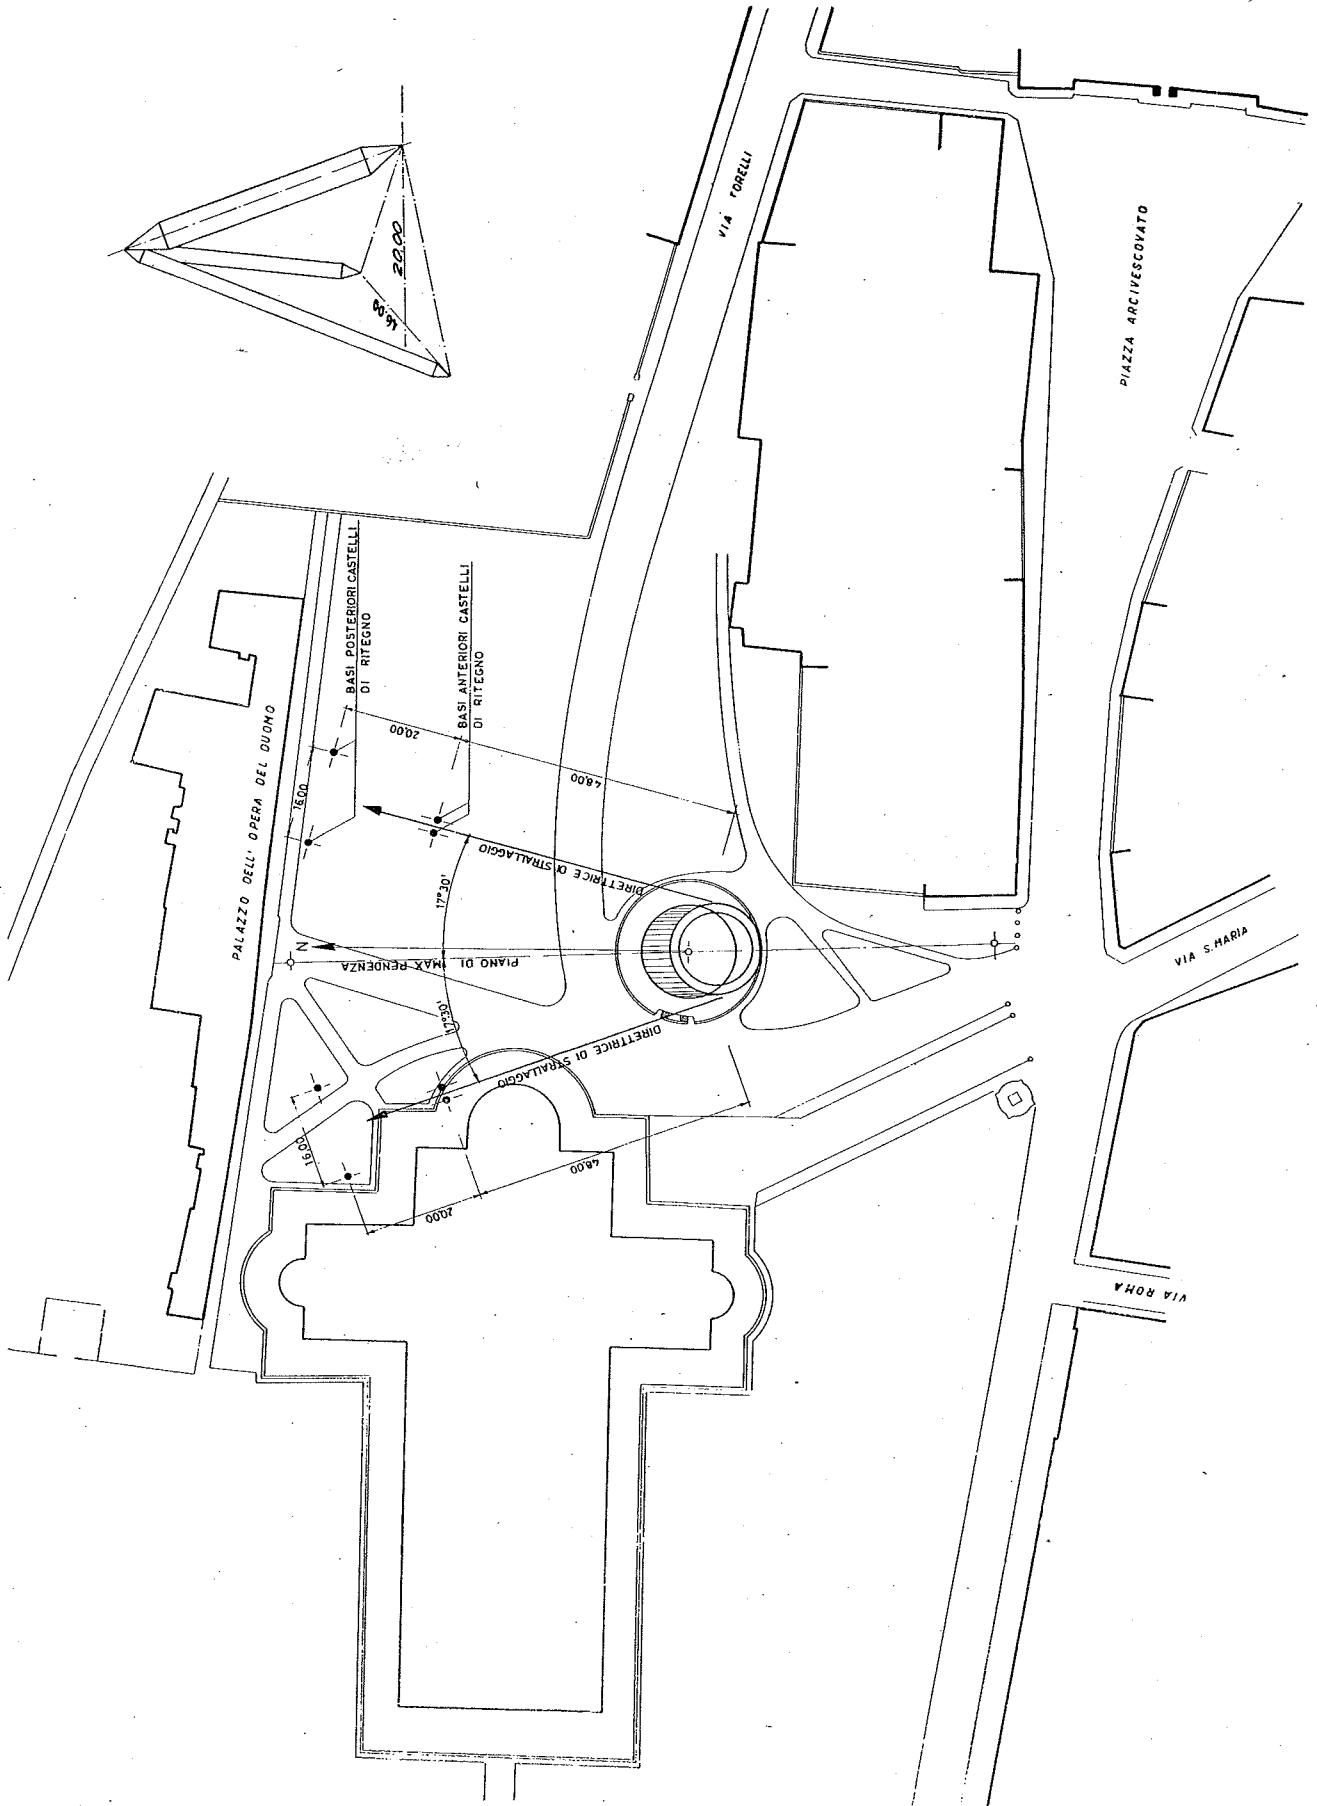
Schema planimetrico del dispositivo provvisorio di sicurezza.
